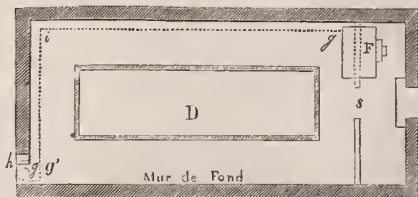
Plan d'une serre chauffée à l'air chaud.
